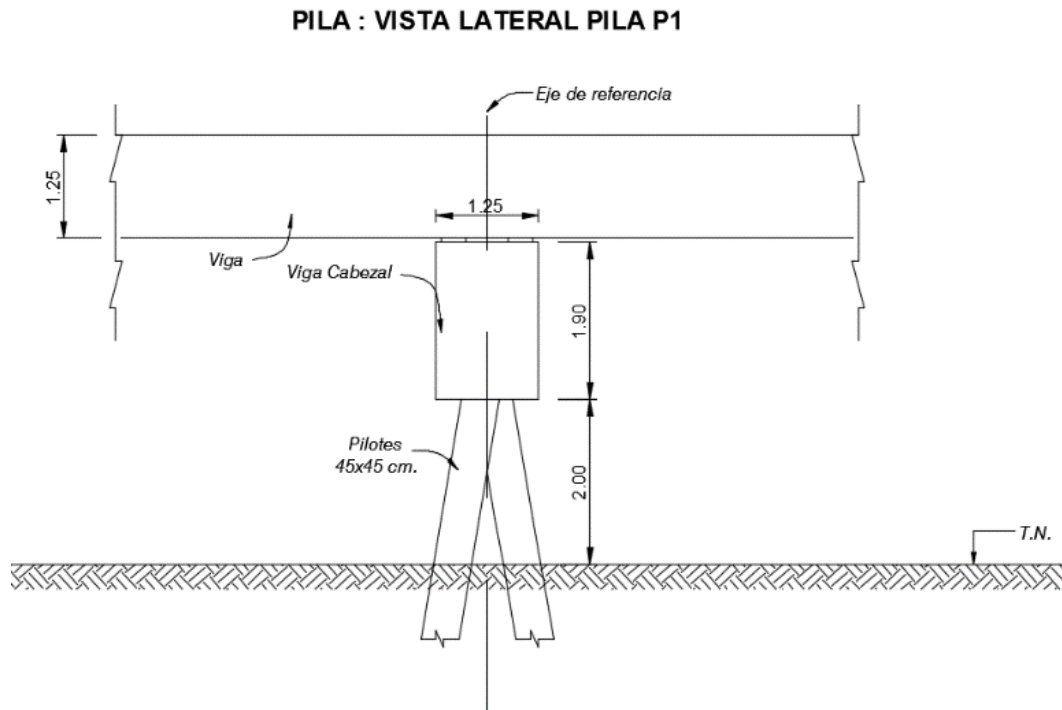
Vista lateral pila P1 del puente de Tarifa.
